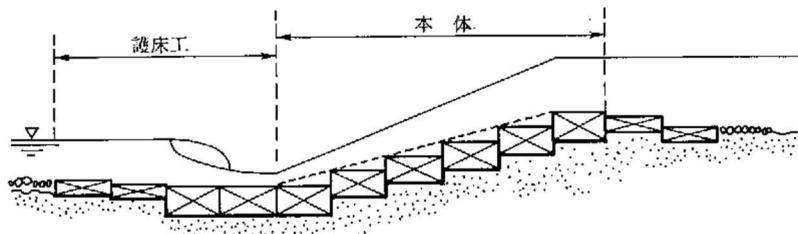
屈とう性構造（コンクリートブロックの場合）
